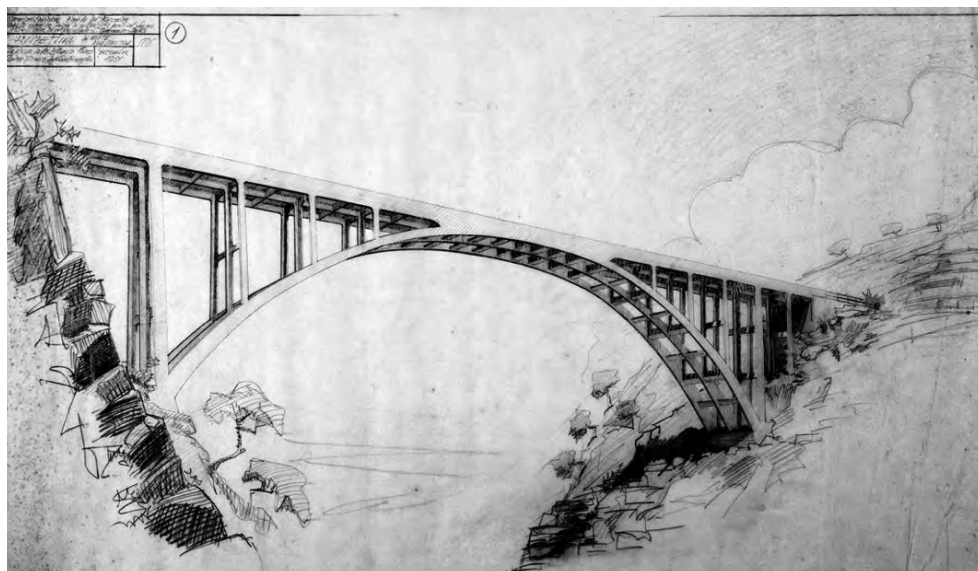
Ing. G. Cantamaglia: ponte di Salle prospettiva.
